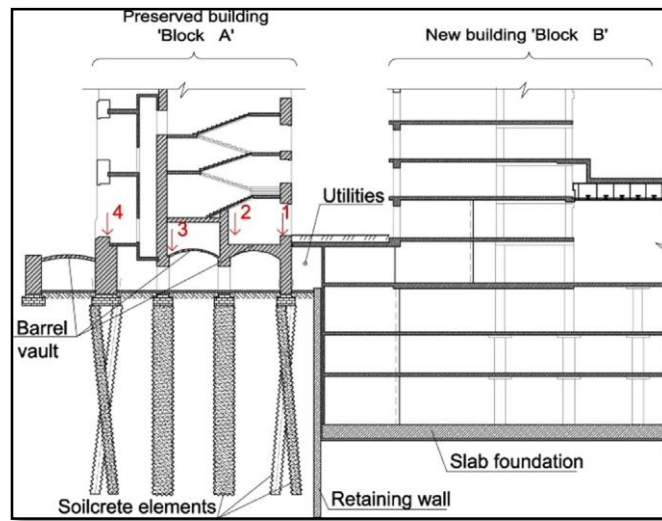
Corte transversal de la nueva construcción subterránea (Bloque B) dentro del edificio preservado (Bloque A).
